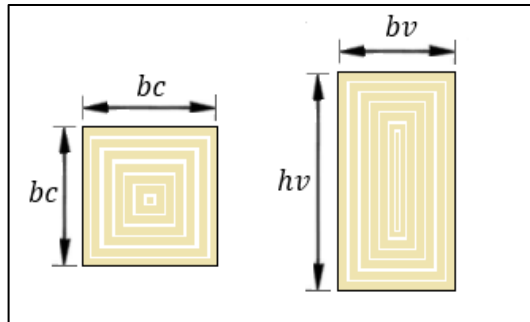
Sección cuadrada de columna y sección rectangular de viga.
